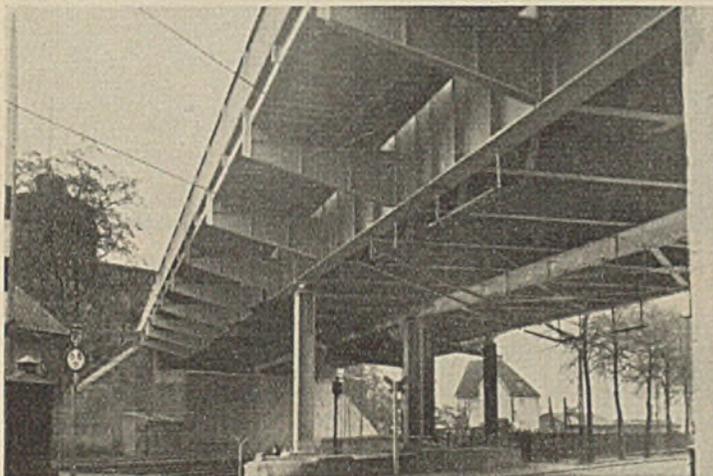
Kreuzungsbauwerk in Mainz-Süd.
